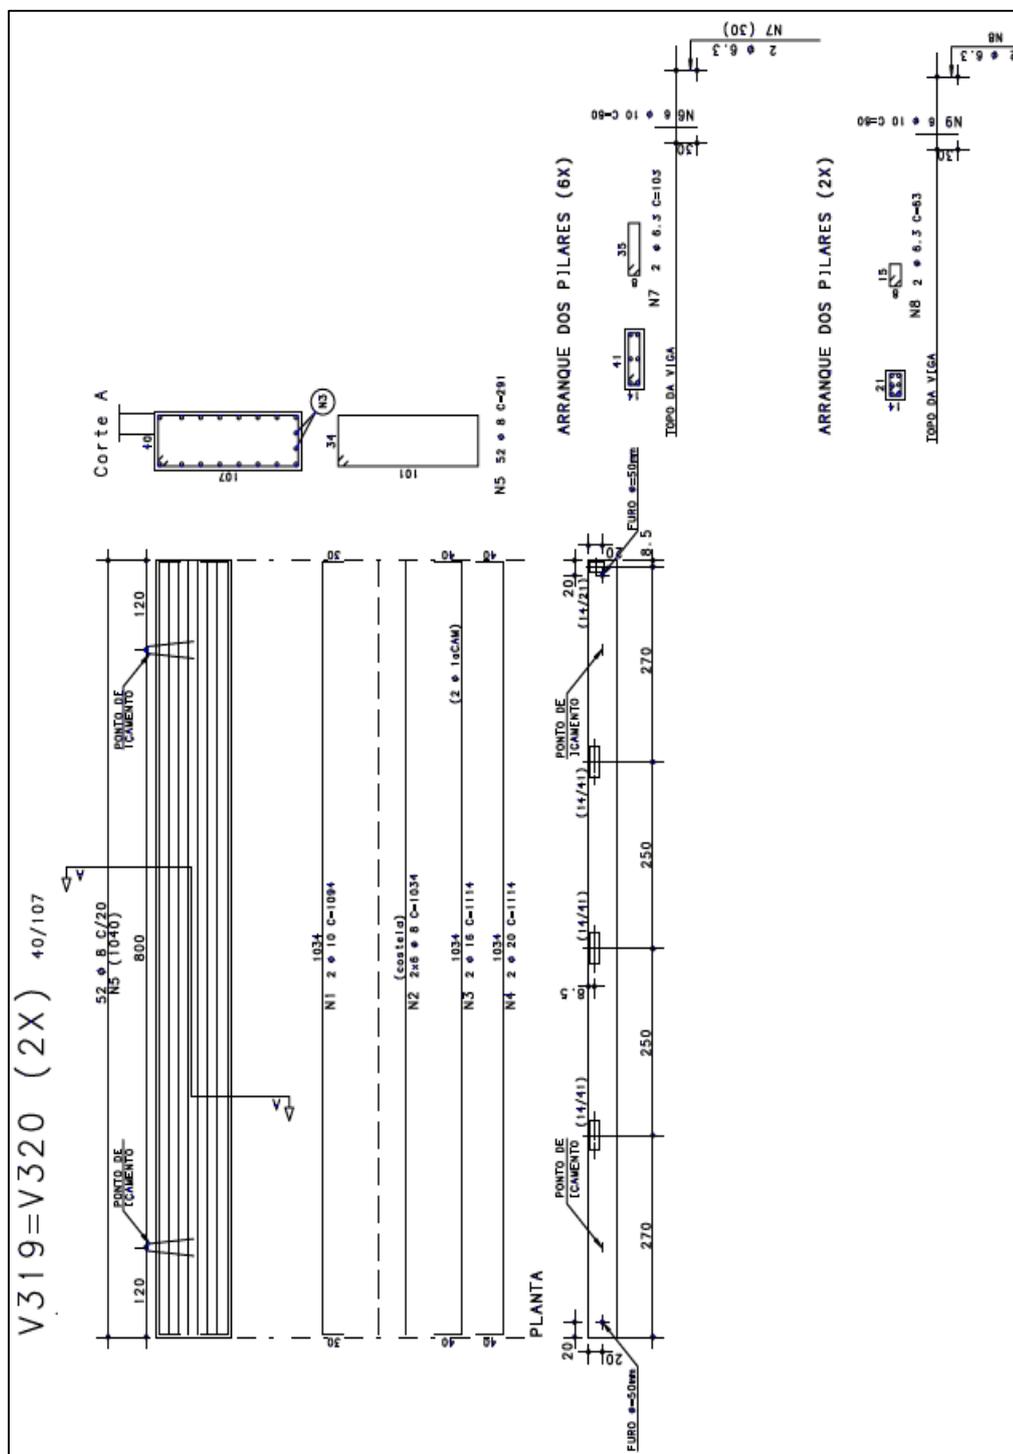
Projeto estrutural da viga V320. Fonte: Contrutora Reynold (2018).
